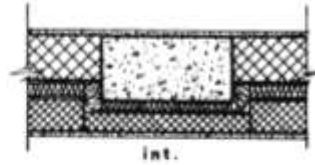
A-2: Pilastro di facciata: ponte termico corretto mediante variazione di forma del pilastro e inserimento di isolante.
